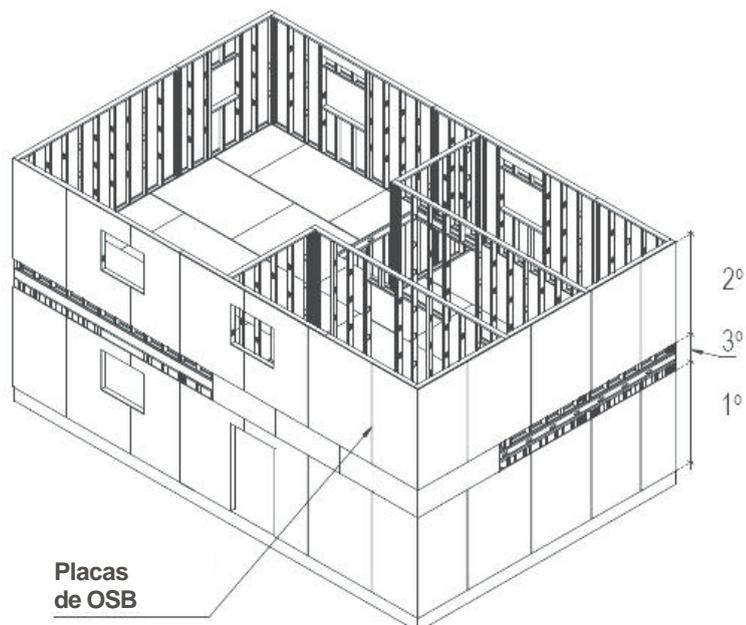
Emplaceamento dos painéis externos. (Adaptado de Consul Steel, 2002)
